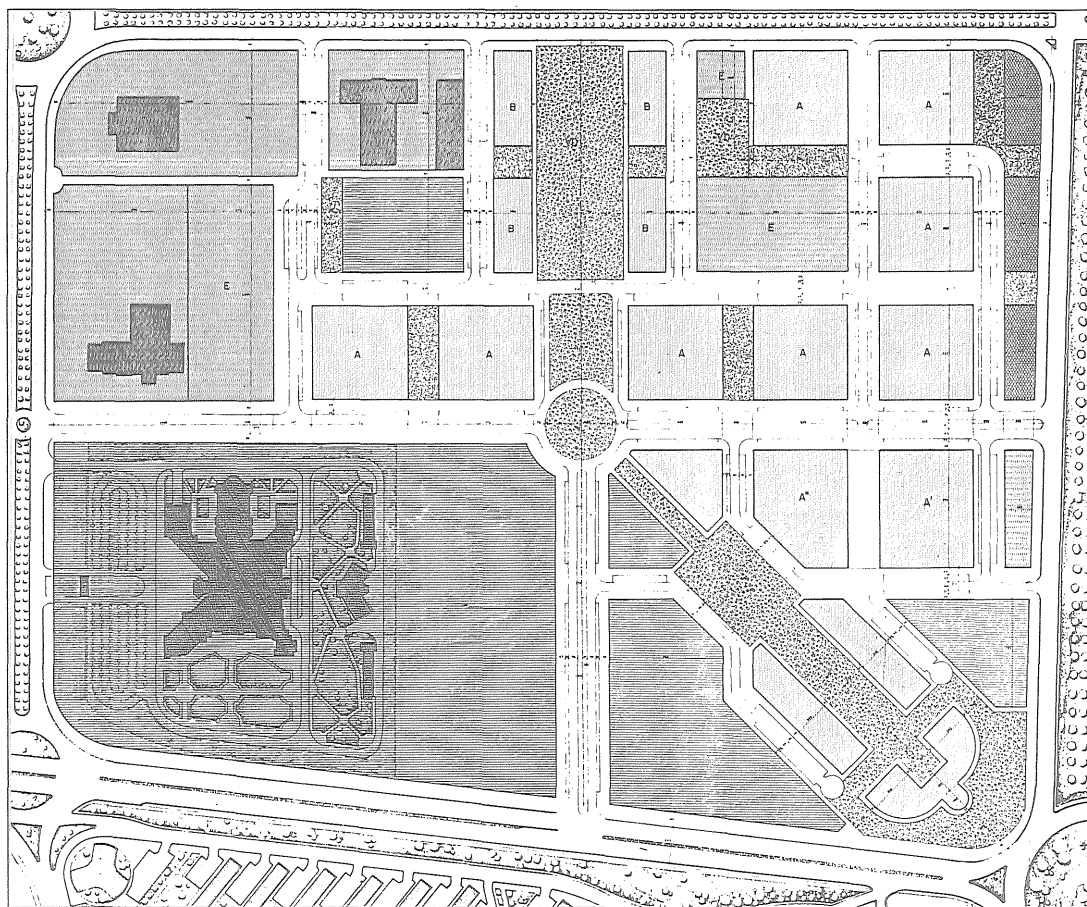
Plan Parcial del Sector n.º 2 de Lakua, 1985. Plano de calificación pormenorizada (e = 1:1000); construido sobre el plano de Alineaciones, describe el uso del suelo y el sistema tipomorfológico de ordenación por referencia a la respectiva Ordenanza que desarrolla las condiciones de edificación para cada uno de los usos descritos.
